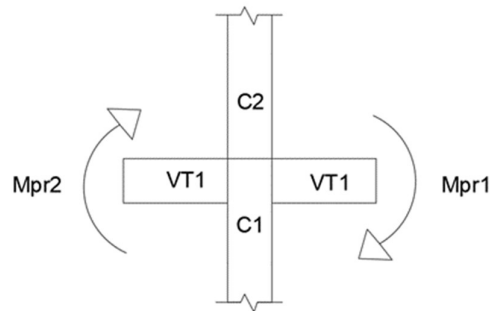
Interacción vigas-columnas en evento sísmico (Boza y D'Steffano, 2023)
